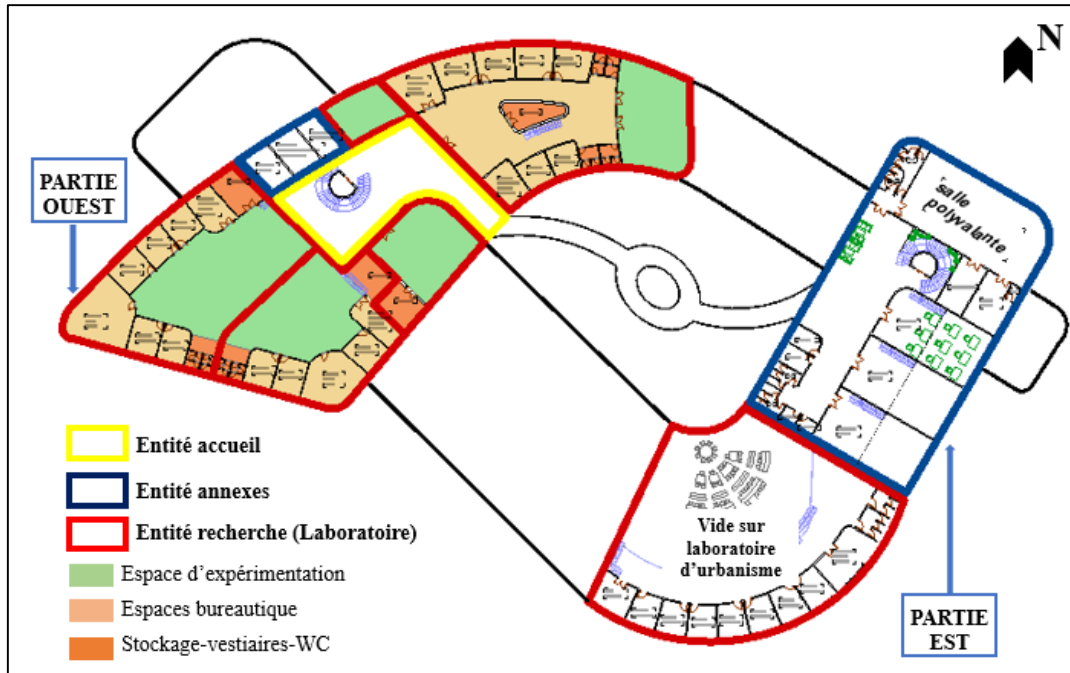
Plan 2ème Etage +12.00 Source : Auteur
